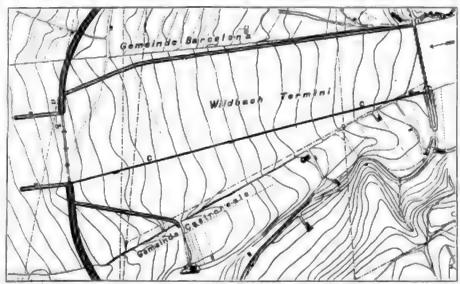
Lageplan der Unterführung des Wildwassers Termini.
